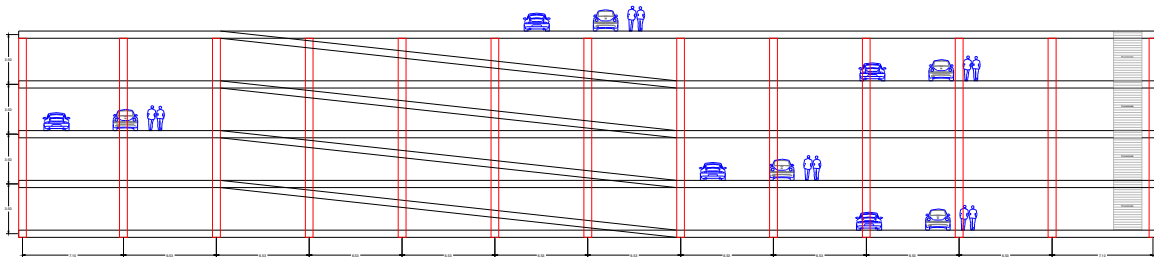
Corte De Planta Nivel 3 De Estacionamiento
